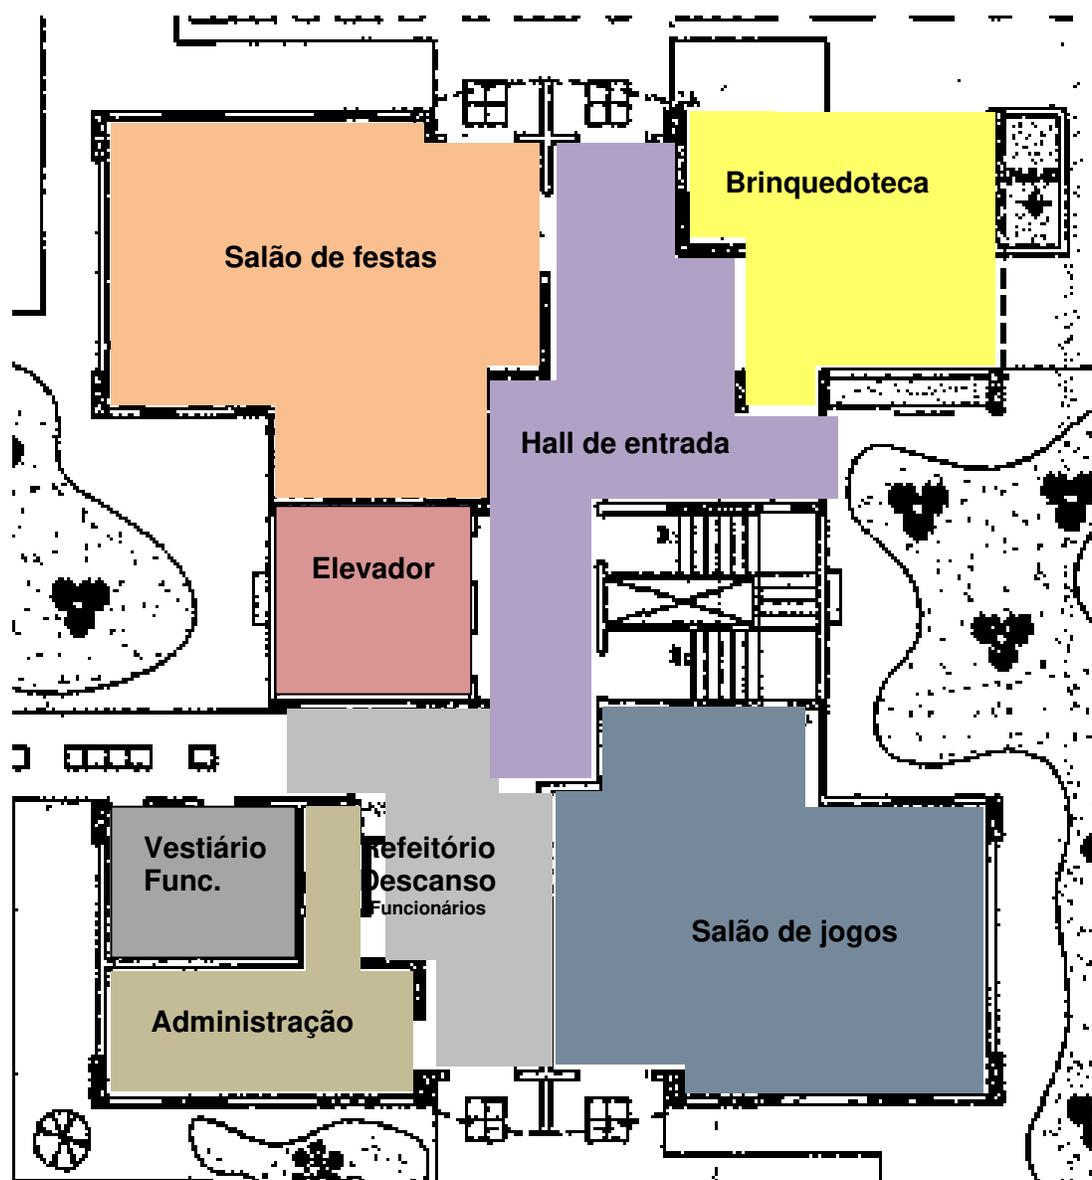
Edifício Cannes. Fonte: a partir da planta original de implantação e paisagismo.
